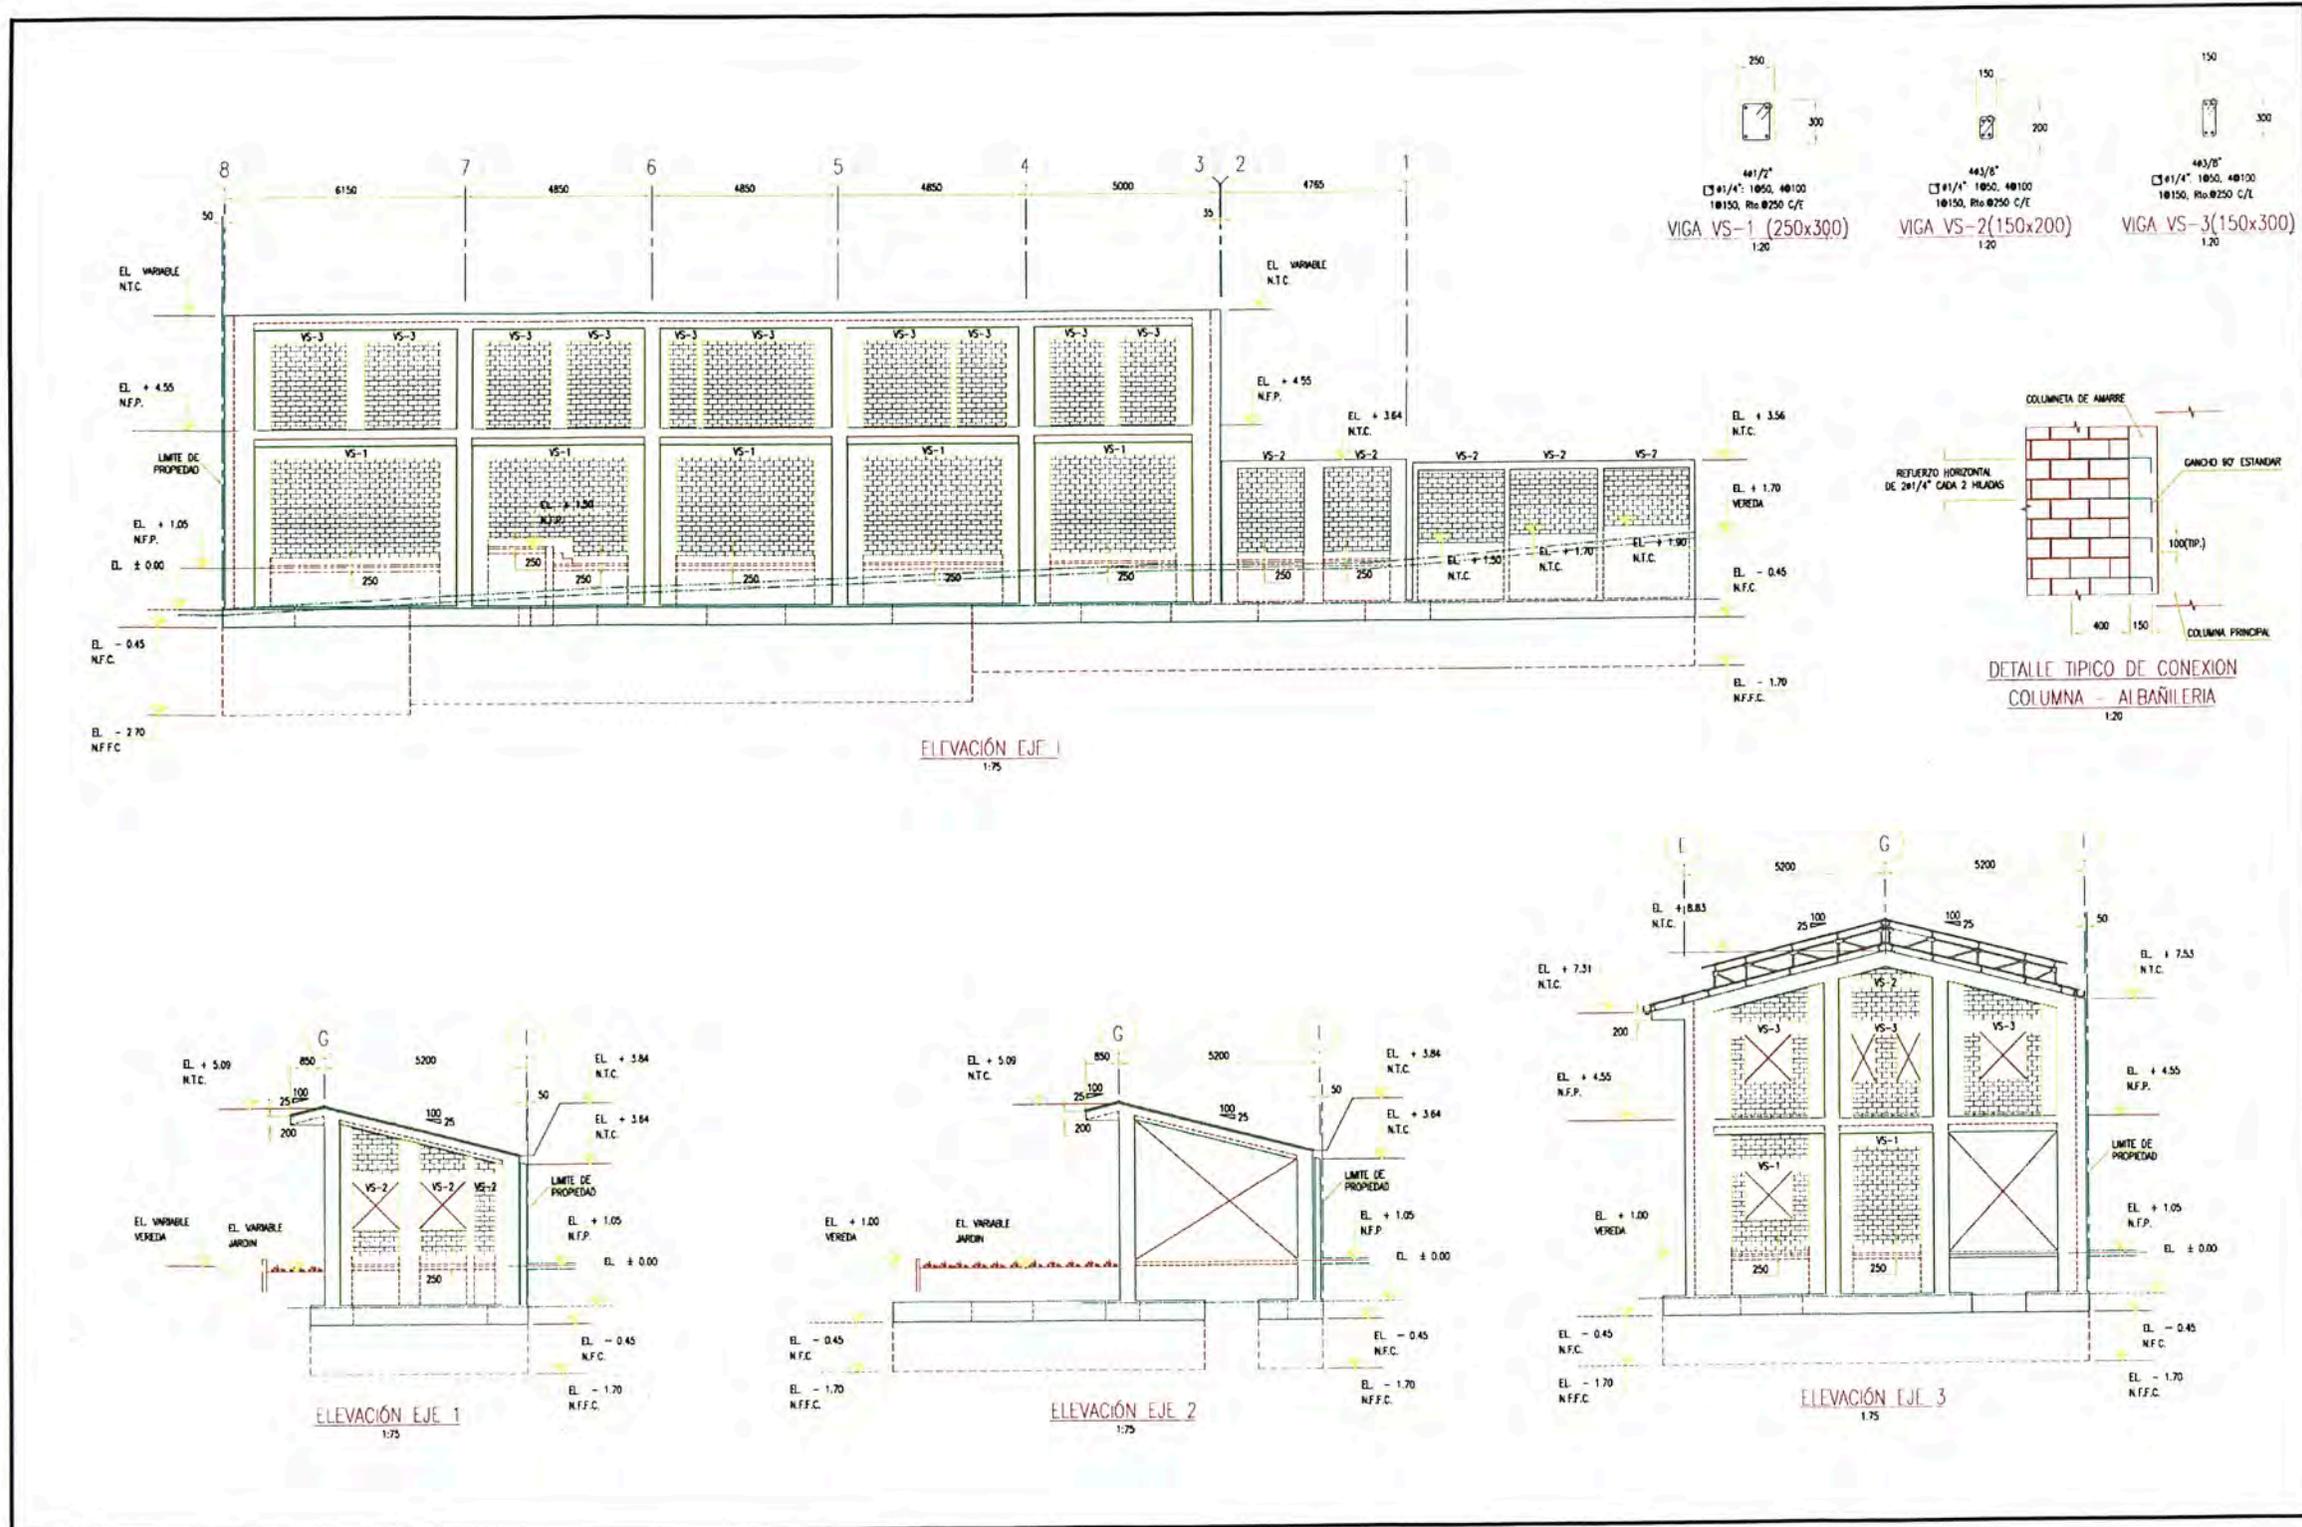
Plano de Estructuras, elevación de pórticos
